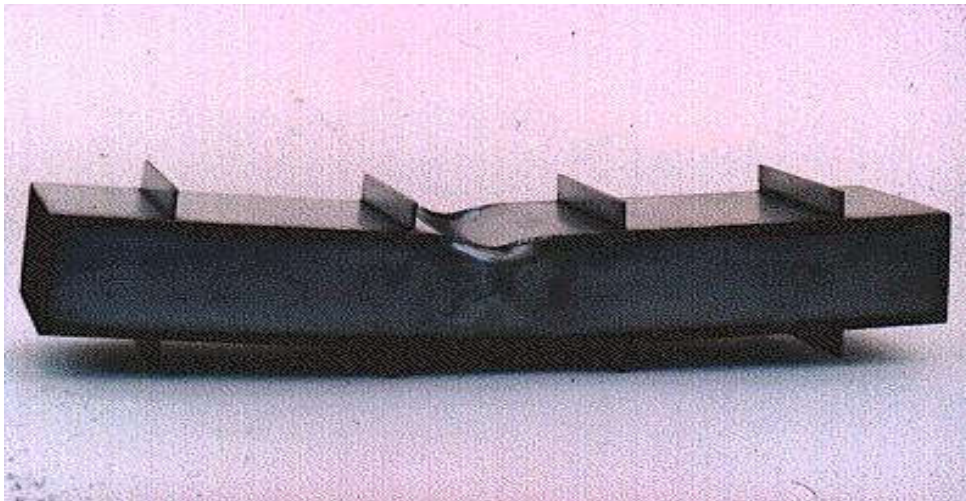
Ruine de la semelle comprimée d'une poutre en caisson.
